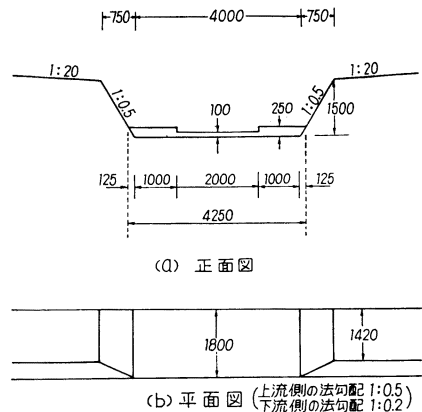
音長川防災ダム水通し部断面と量水堰 (単位: mm)
